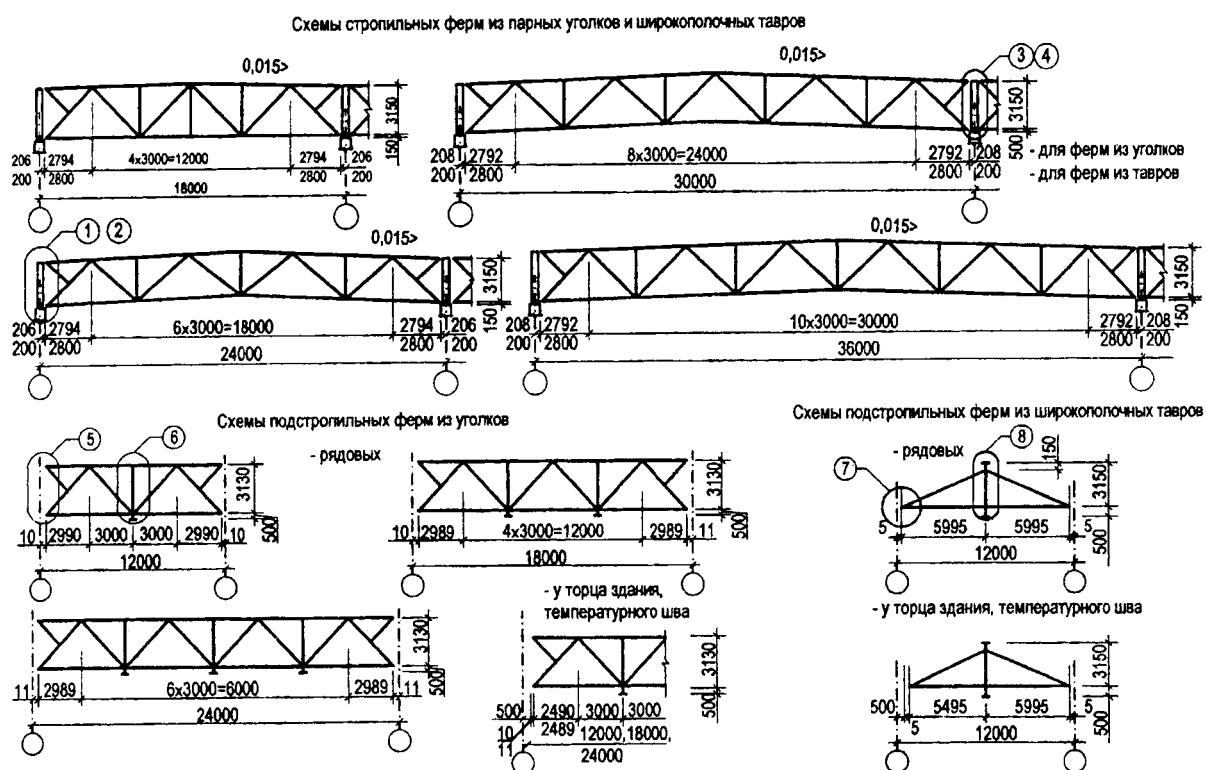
Геометрические схемы стропильных и подстропильных ферм из парных уголков и широкополочных тавров
